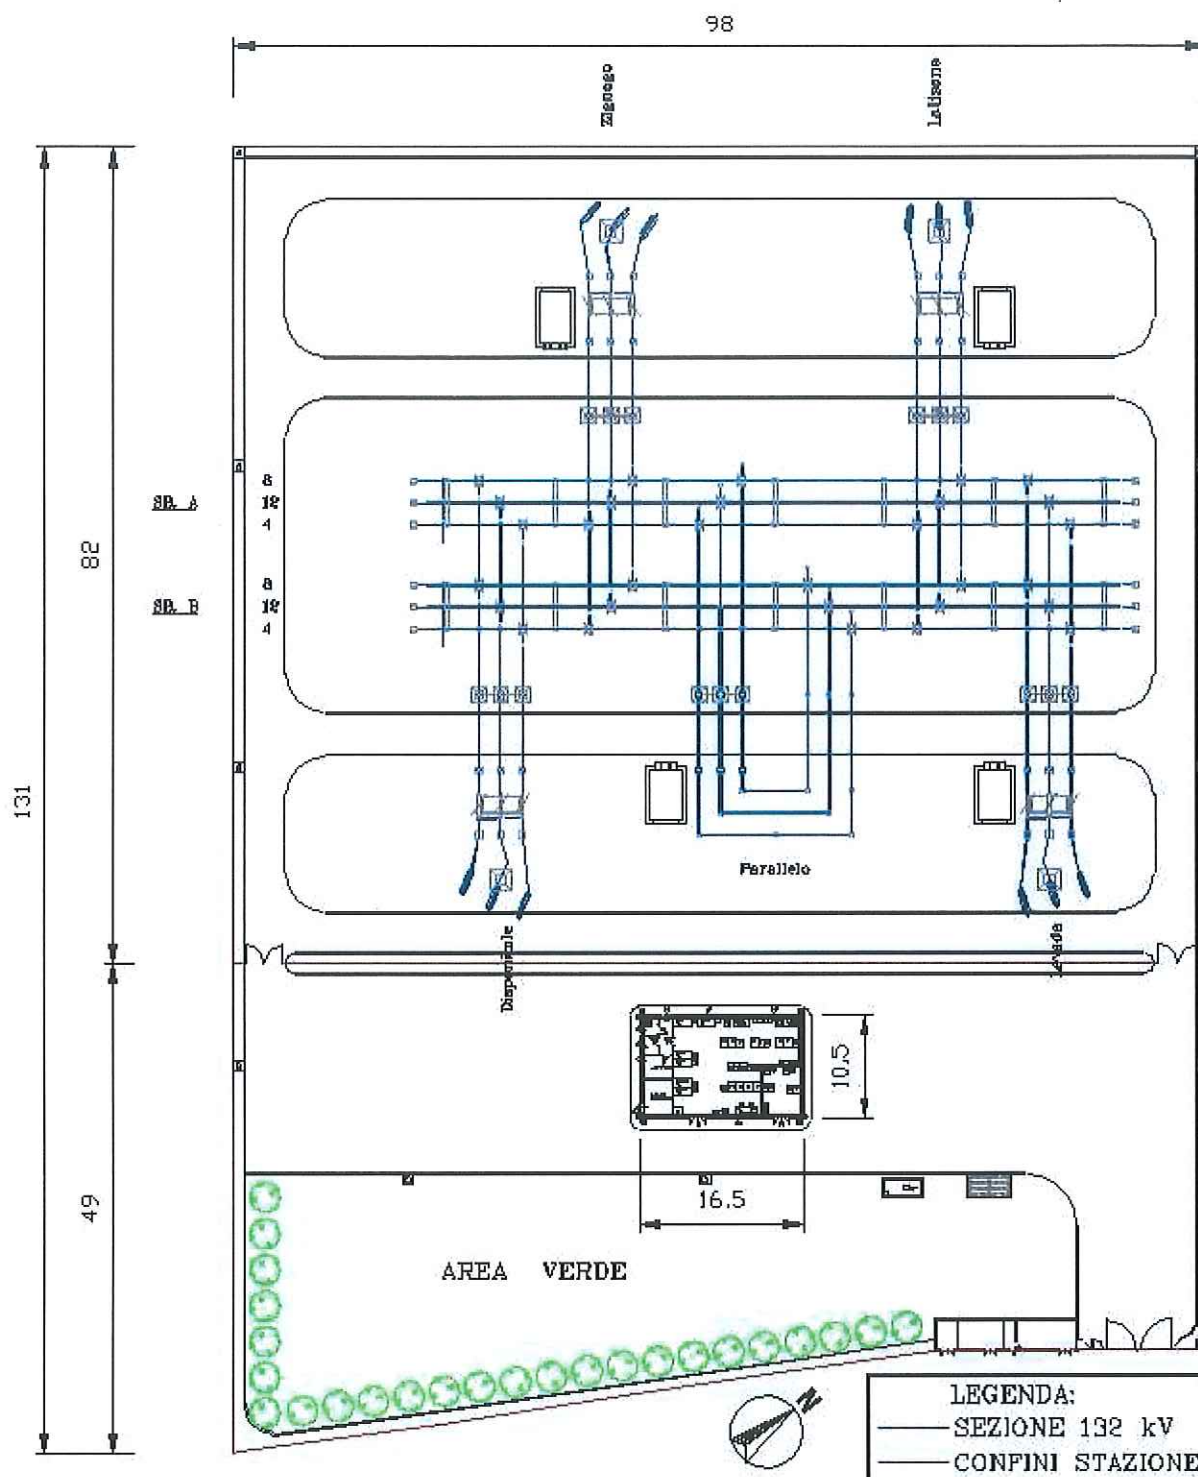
S.e. di Fossalta – Planimetria nuovo impianto
